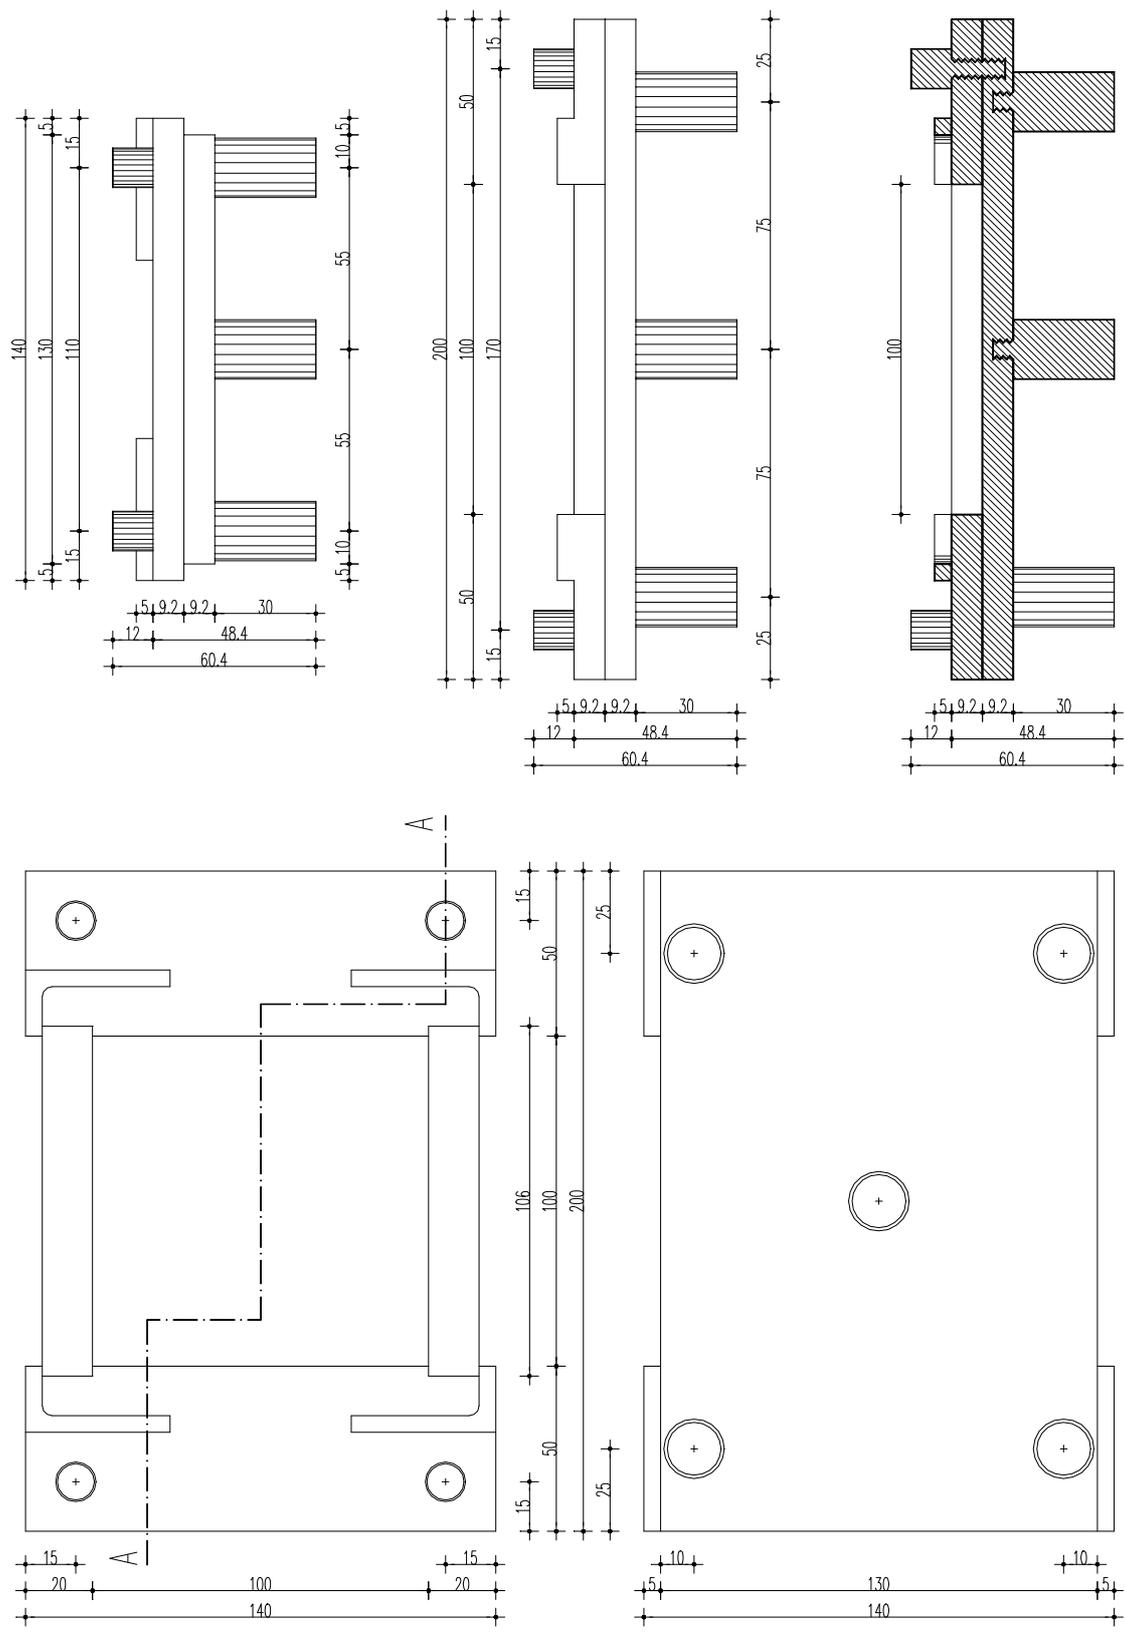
DETTAGLIO DI PROGETTO DEL BASAMENTO: PIANTA, PROSPETTI E SEZIONE A-A –
